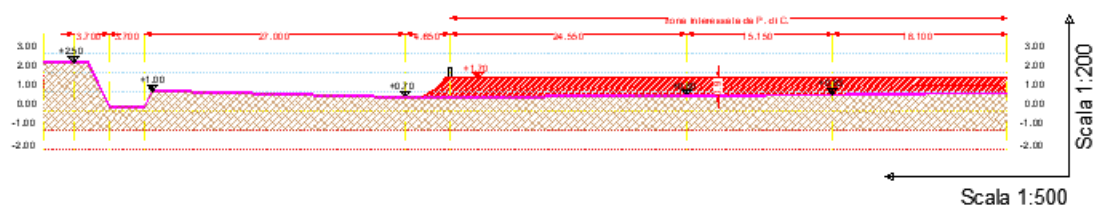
Sezioni di progetto - confronto tra stato di fatto e stato di progetto.
